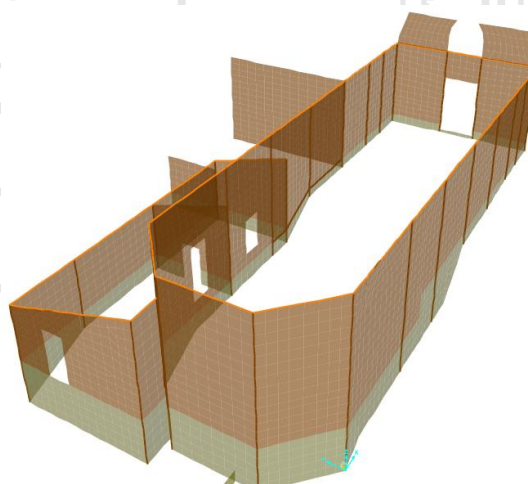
Ubicación del refuerzo viga collar en el modelo estructural.
